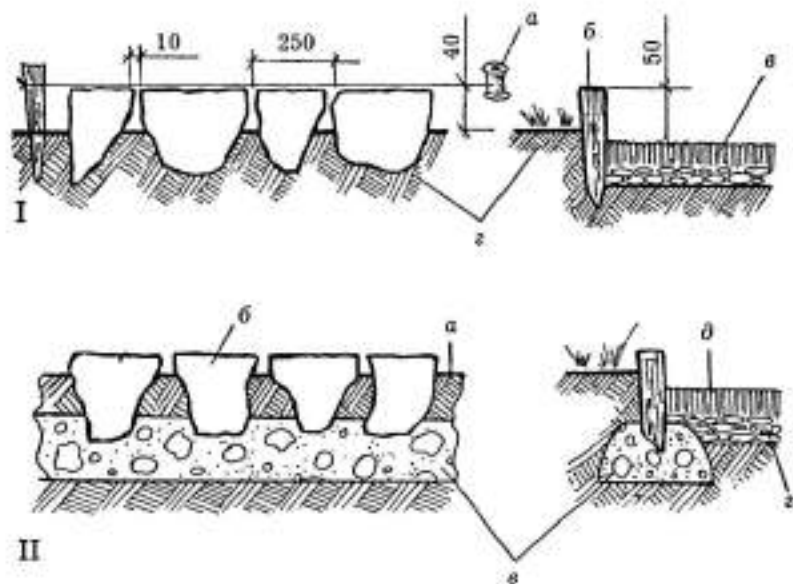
I — бордюр из плоского природного камня, установленный по шнуру: а — шнур; б — камень; в — площадка; з — грунт; II — бордюр из плоского природного камня на бетонном основании: а — шнур; б — камень; в — бетон; з — насыпной грунт; д — площадка
